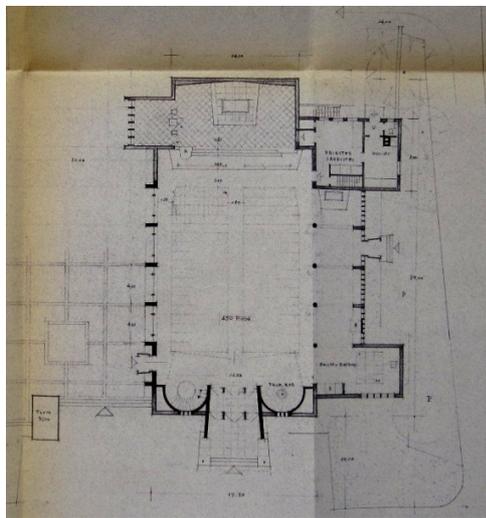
Vorentwurf für den Neubau. Plan 2, Grundriss (Ausschnitt), O. Hodler, undatiert
